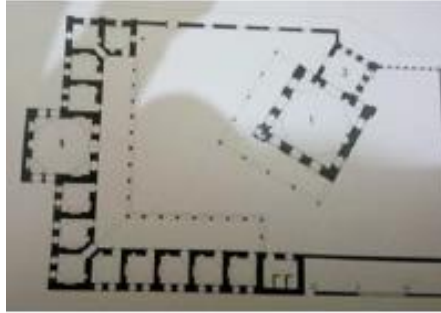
مسقط أفقي للمسجد الملحق بمدرسة أنجة منار لي بقونية
